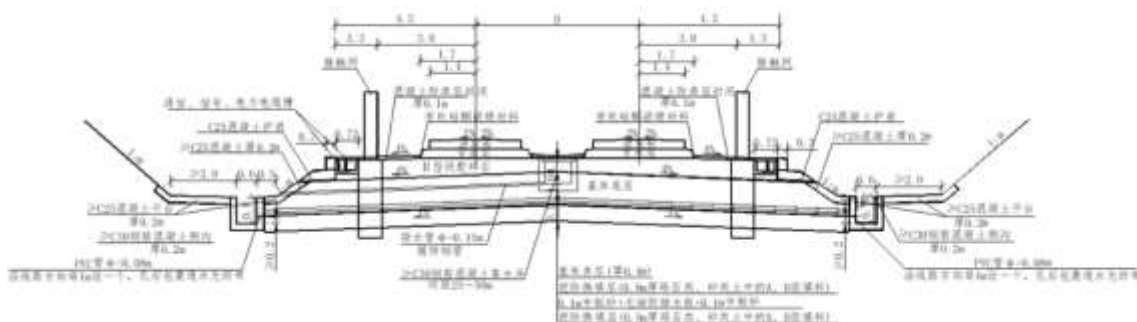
250km/h 双线无砟轨道路堑标准横断面图 (单位: m)
